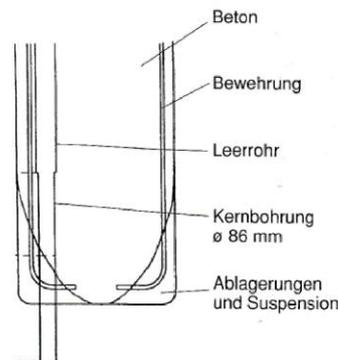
Schematischer Schnitt durch einen Pfahlfuß. Die abgerundete Form wird durch den Einschluss einer Mischung aus Suspension und Ablagerungen zwischen Beton und Untergrund verursacht [16]
